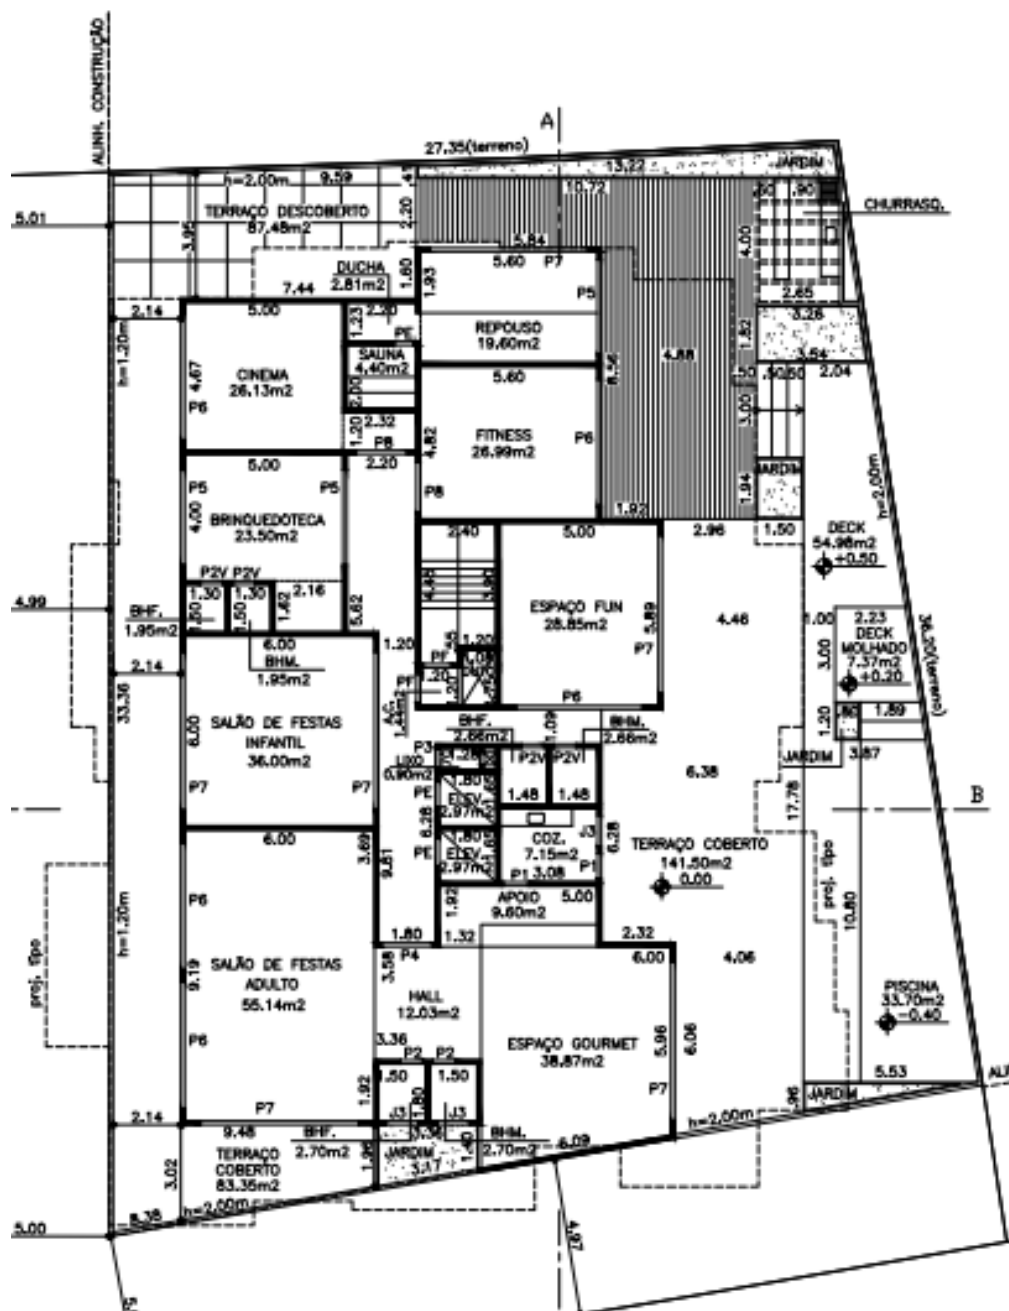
Planta baixa 2º Pavimento – P.U.C.
